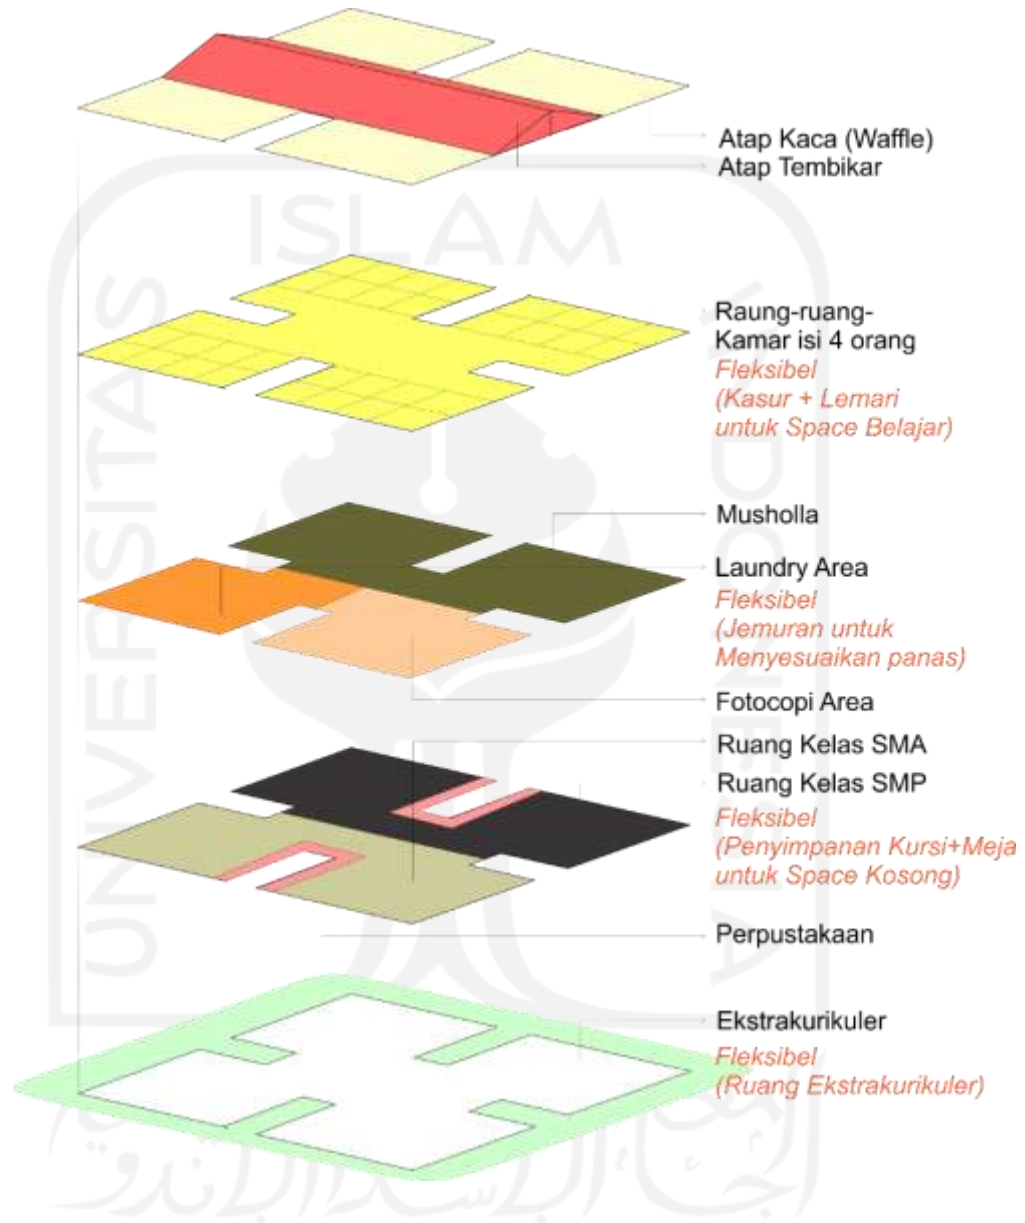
31 Potongan dan Zonasi perlantai Modul Bangunan Siswa
